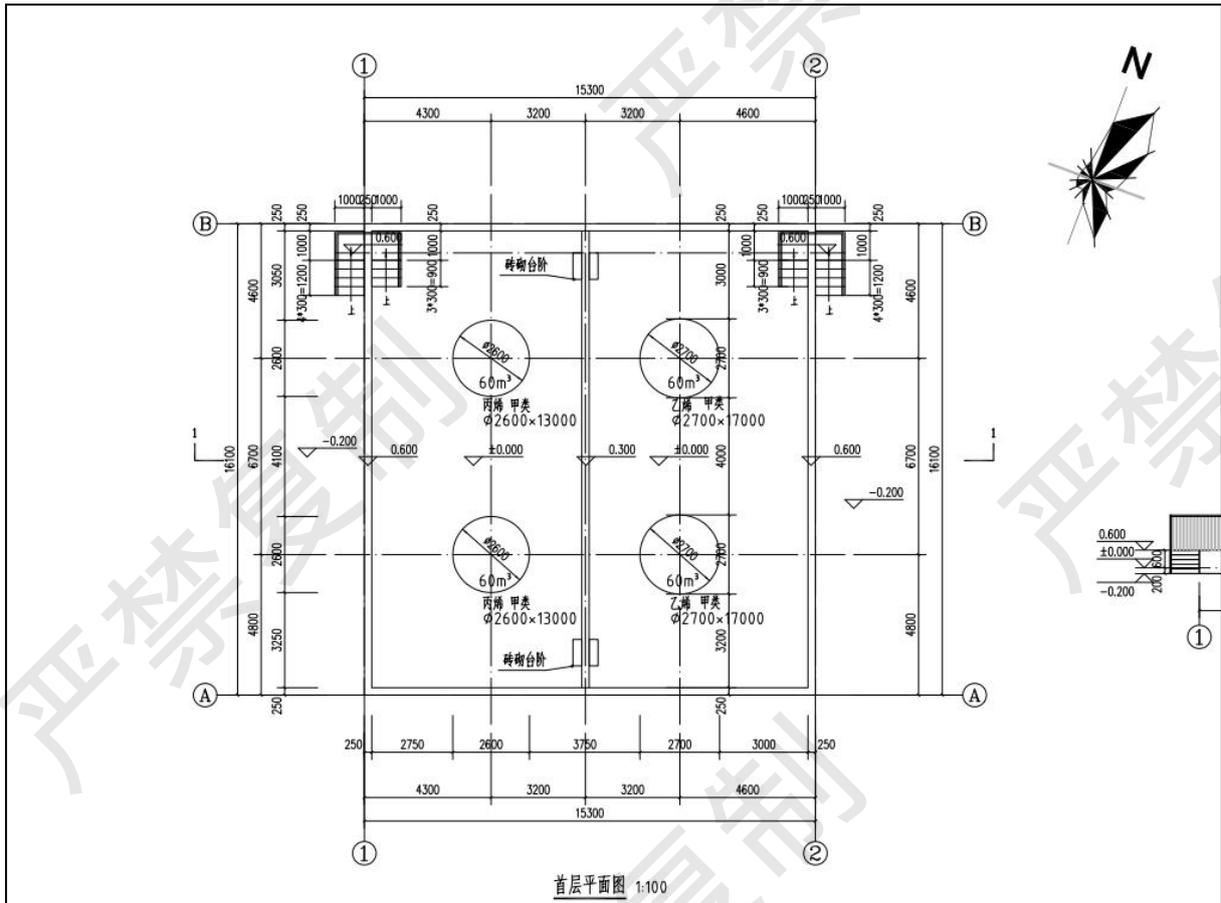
现有项目乙烯丙烯罐区平面布置图
